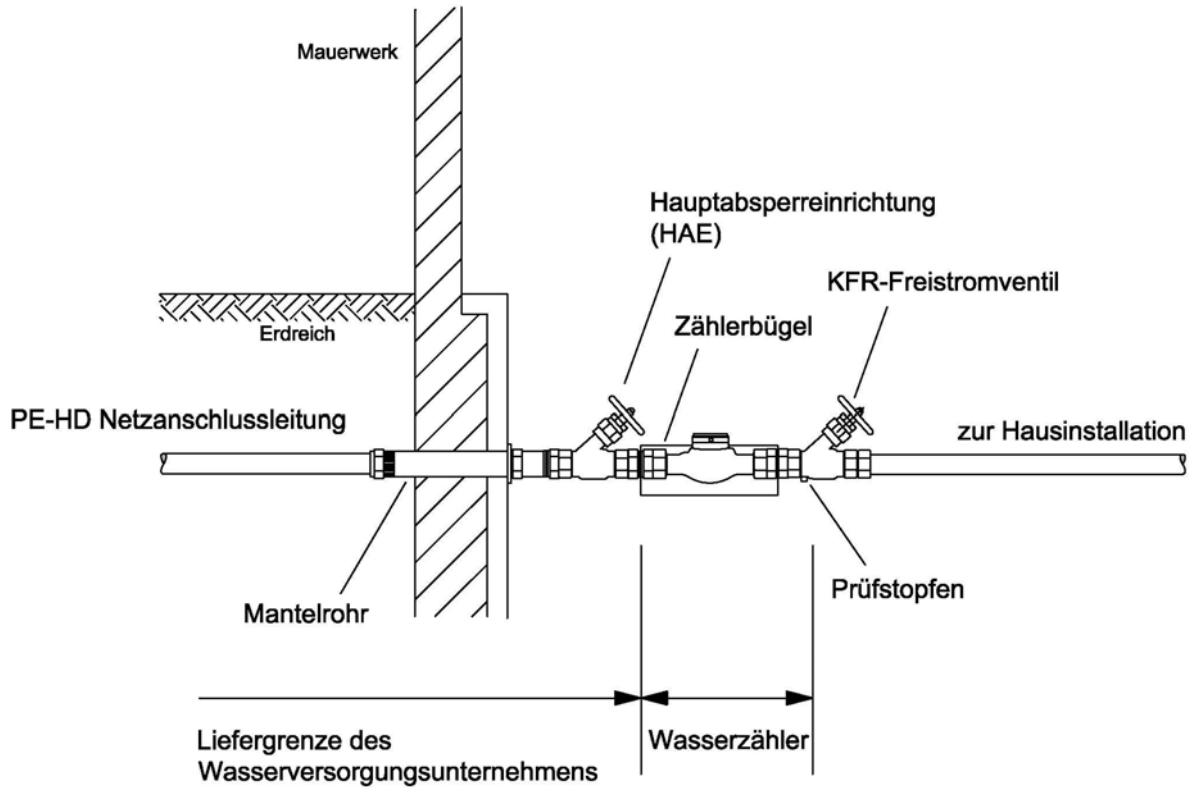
Installationsschema für Hauswasserzähler bis Qn 10
